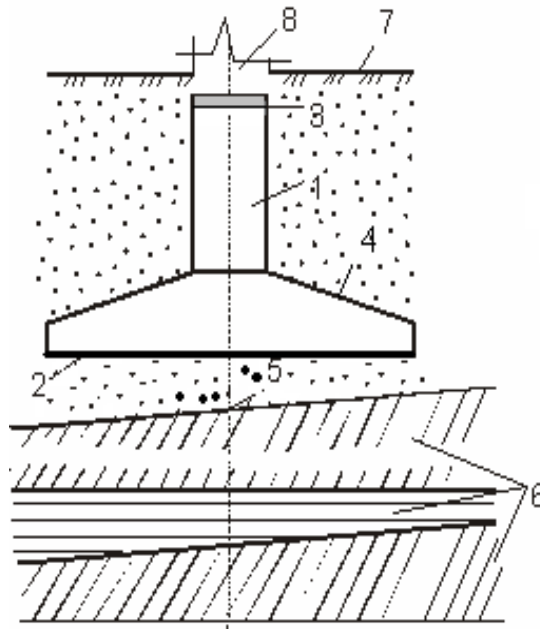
Фундаменту неглибокого закладання: 1 – фундамент; 2 – підшва фундаменту; 3 – обріз фундаменту; 4 – уступ фундаменту; 5 – несучий шар ґрунту; 6 – шар, на який опирається фундамент та підстильні шари ґрунтів; 7 – поверхня землі; 8 – надземна конструкція
